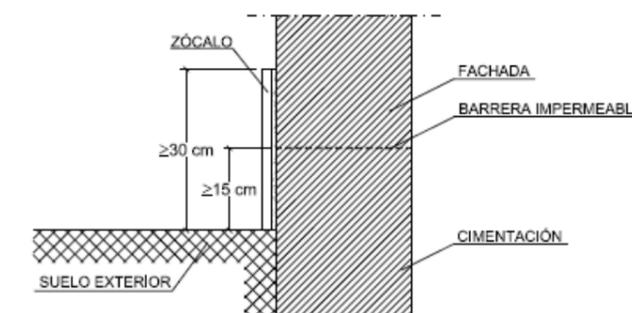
Ejemplo de arranque de la fachada desde la cimentación
